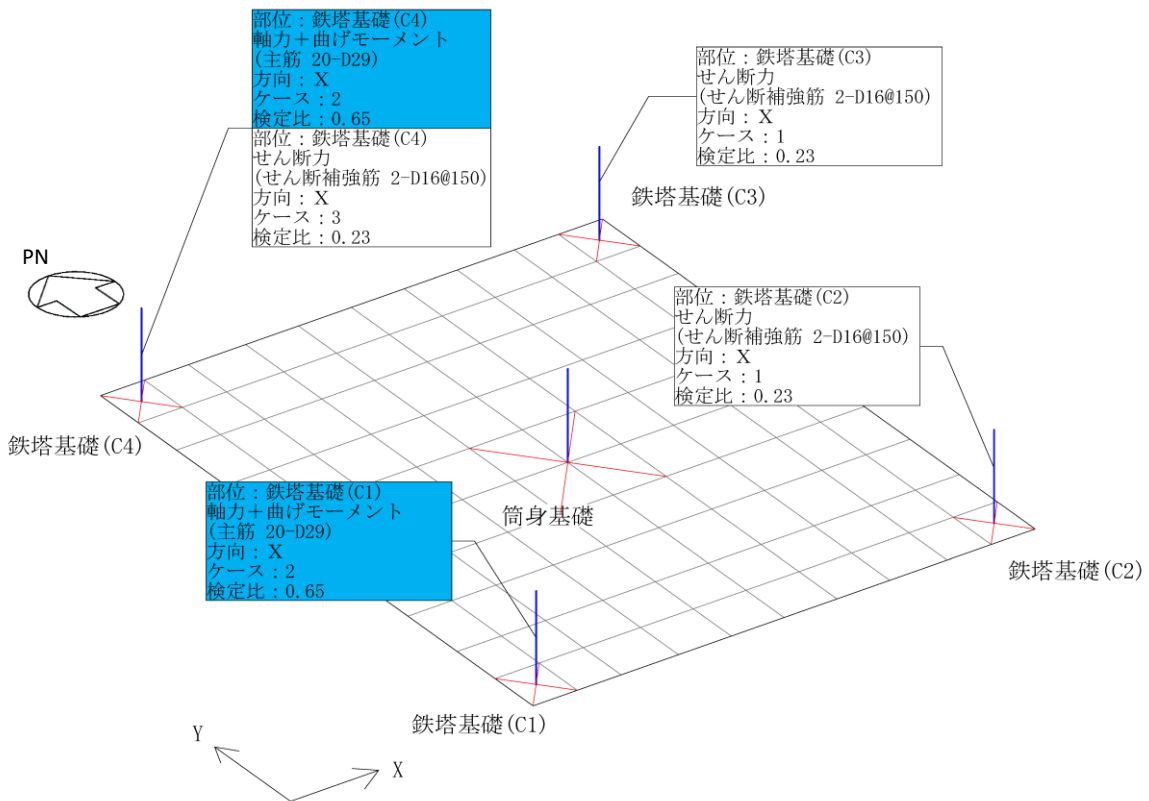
鉄塔基礎及び筒身基礎の概略配筋図
